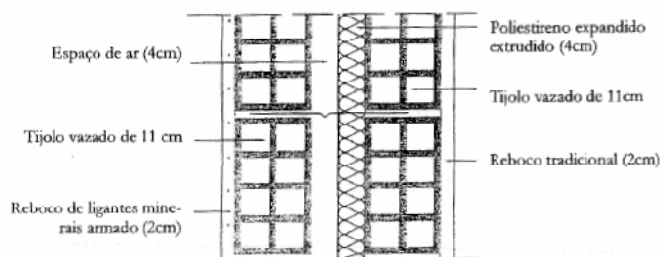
Parede dupla com panos iguais em alvenaria de tijolo vazado [14]
